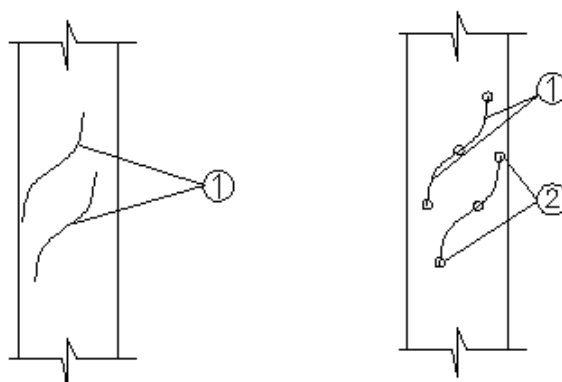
Inyección de Grietas en Columnas
